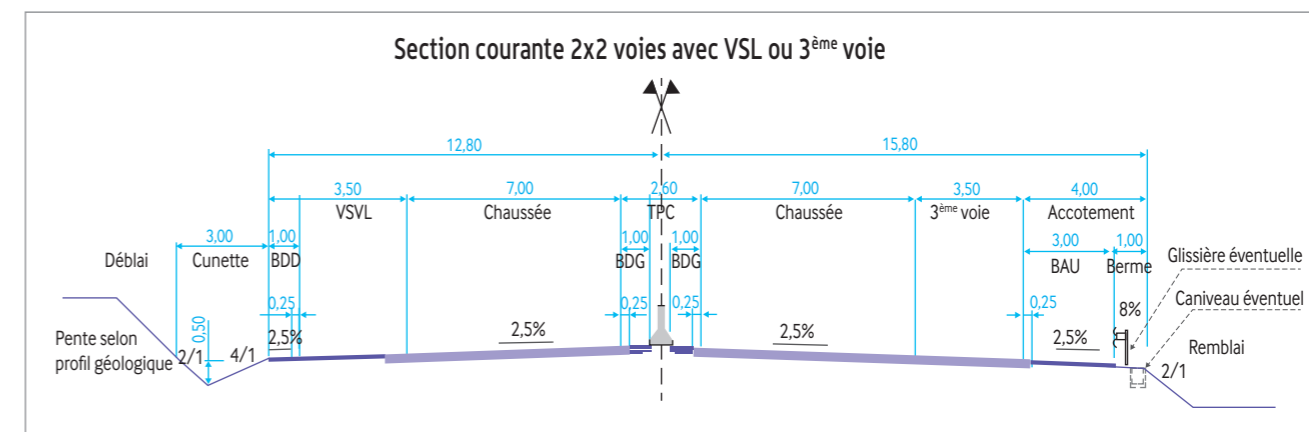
PROFIL EN TRAVERS TYPE DANS LE CAS D'UNE VSVL OU D'UNE 3ÈME VOIE
